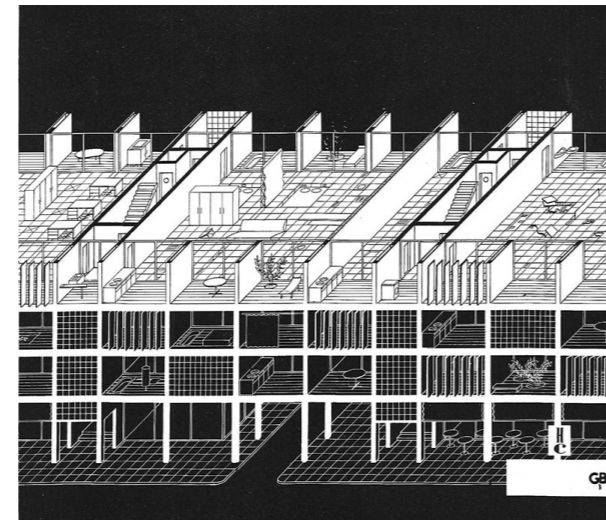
Planta Pan 1988, Desalle y Laucourdre
